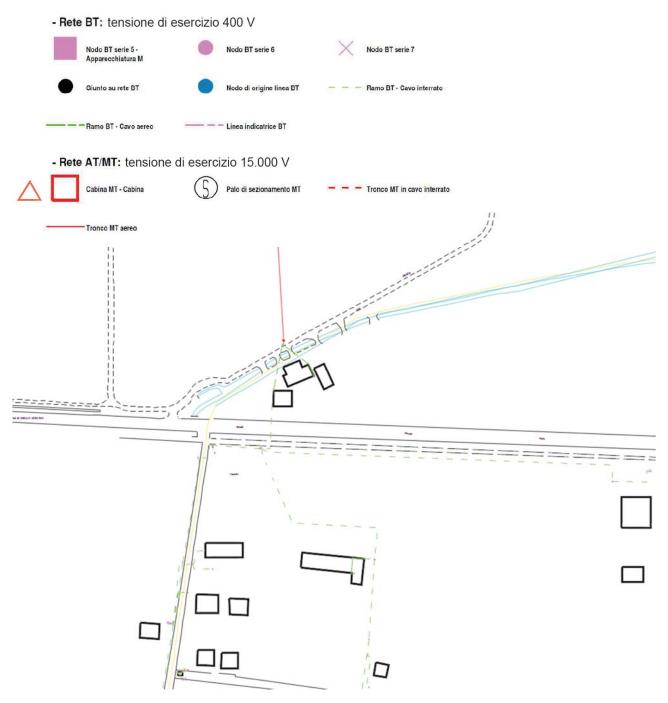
Tracciato rete elettrica inviato dall'Ente
